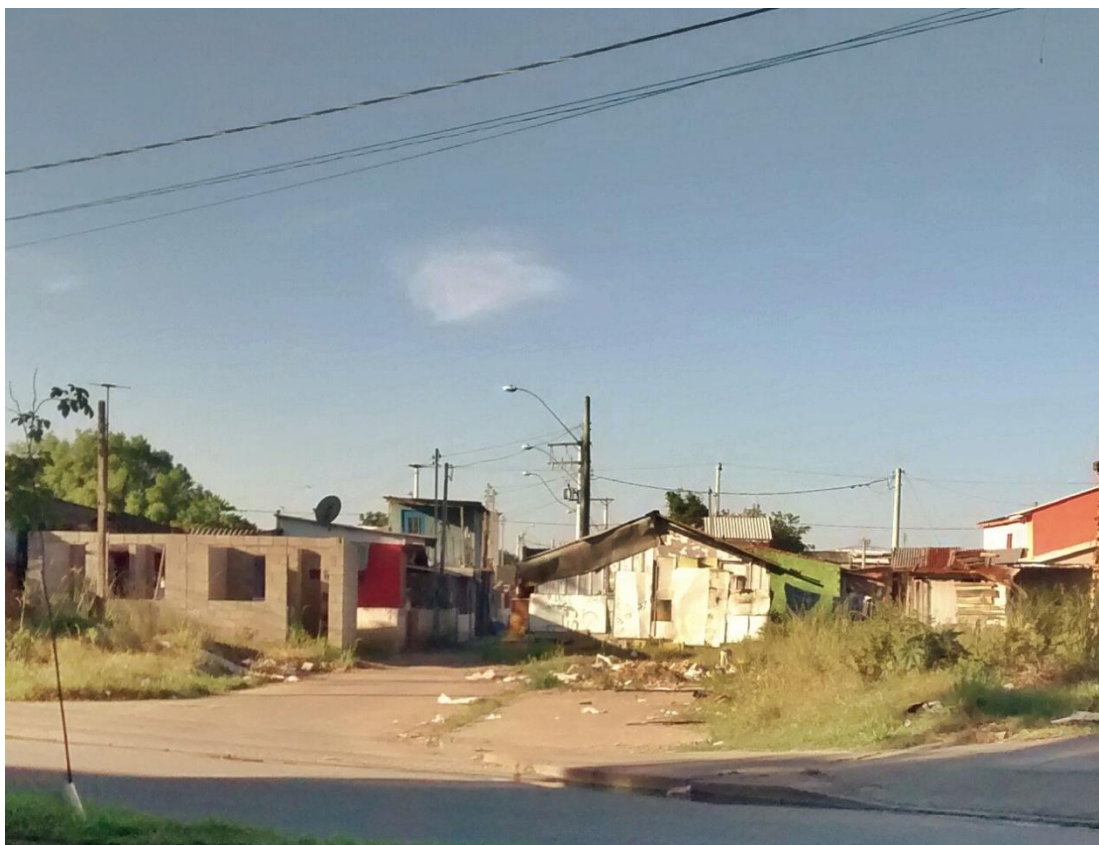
Autoconstrução no trecho duplicado da Rua Dona Teodora, bairro Farrapos.
